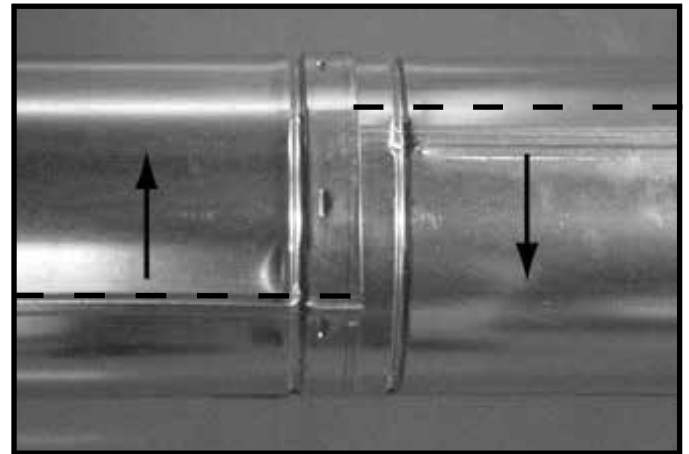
Faire tourner les joints d'assemblage pour le démontage
